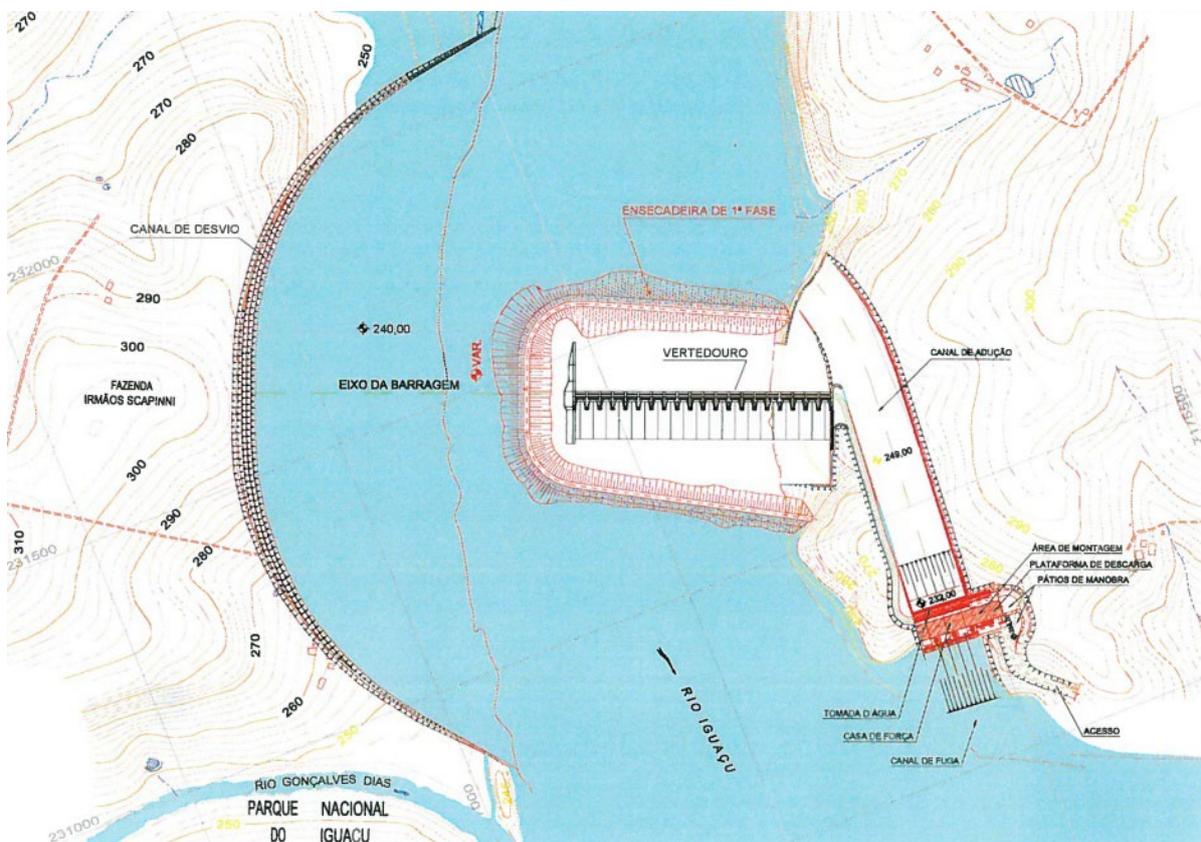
Desvio do rio em diversas fases. 1ª Fase. Desvio pelo leito estrangulado e canal lateral. UHE Baixo Iguaçu, PR.
